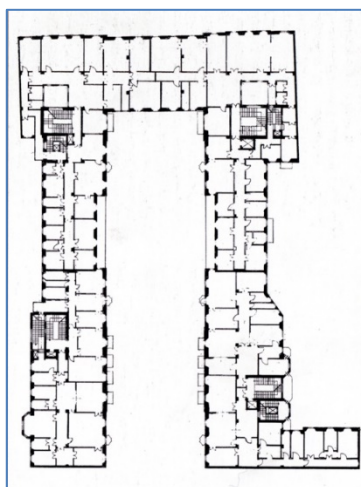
Pianta del 5° piano (Archivio Portaluppi)
